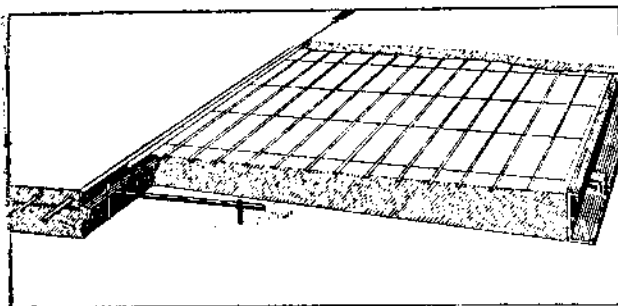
Расположение арматуры и шпунта в железобетонной дорожной плите.
